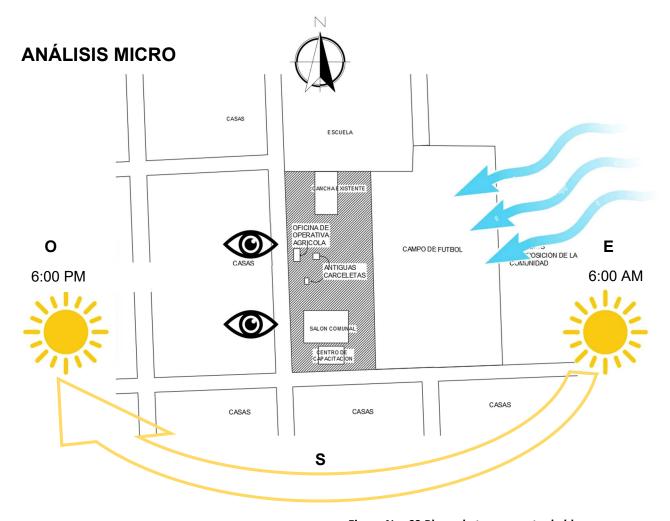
Plano de terreno actual aldea la campesina Fuente: Elaboración Propia
